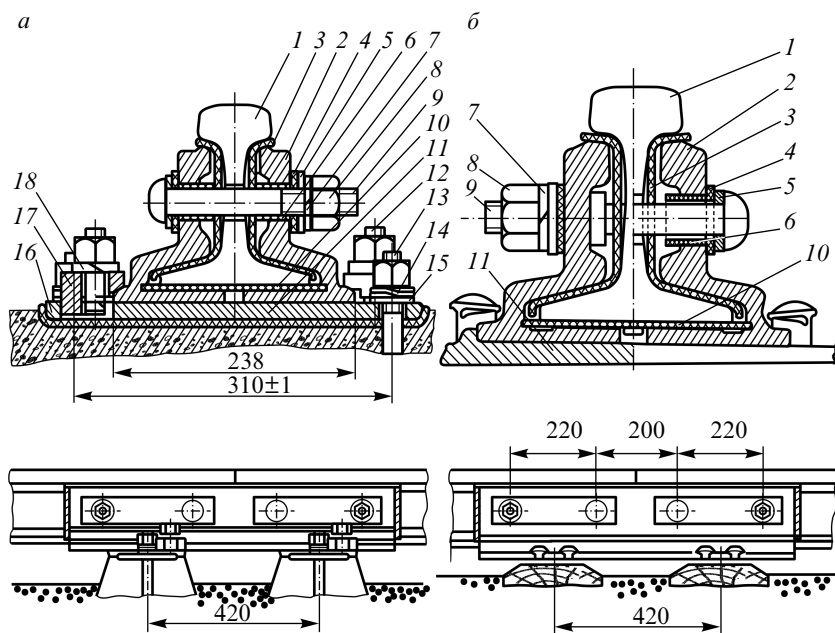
Изолирующий стык с объемлющими металлическими накладками: а — при железобетонных шпалах и креплении КБ; б — при деревянных шпалах с костыльным креплением; 1 — рельс; 2 — накладка; 3 — прокладка боковая; 4 — полиэтиленовая планка под болты; 5 — металлическая стопорная планка; 6 — втулка; 7 — пружинная шайба; 8 — гайка; 9 — стыковой болт; 10 — изолирующая прокладка под рельс; 11 — подкладка; 12 — клеммный болт; 13 — закладной болт; 14 — пружинная шайба; 15 — плоская шайба; 16 — прокладка под подкладку; 17 — клемма; 18 — шайба
